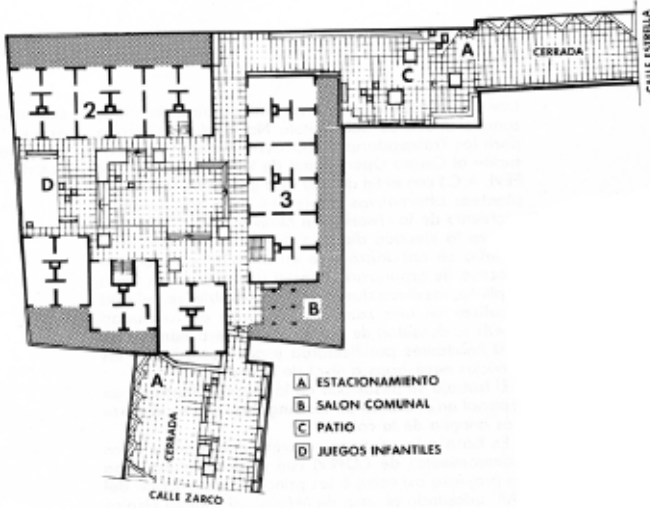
Planta de conjunto del proyecto en la colonia Guerrero (Caso 1).
